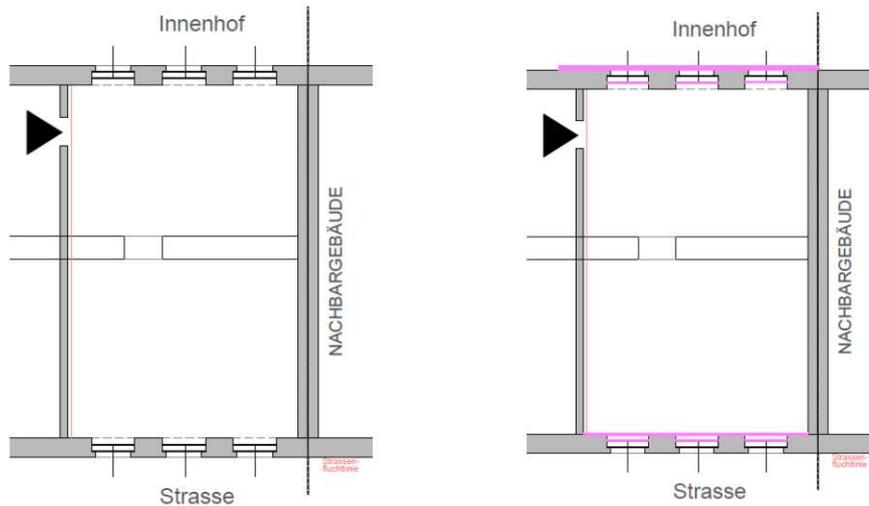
Systemgrundriss 2. Stock: Bestand – Saniert (eigene Darstellung)
